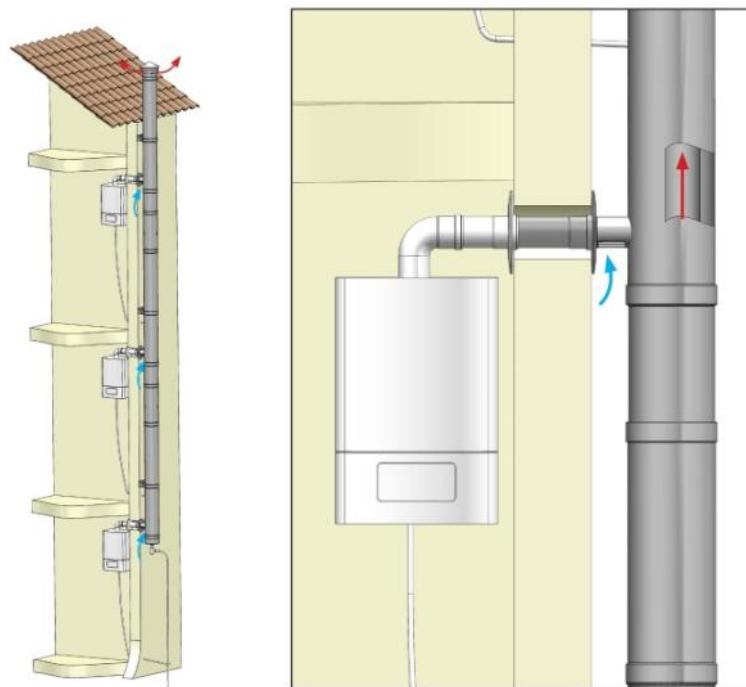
Principe de montage de la version DINAGAS 3CE+ DW à l'extérieur d'un bâtiment
